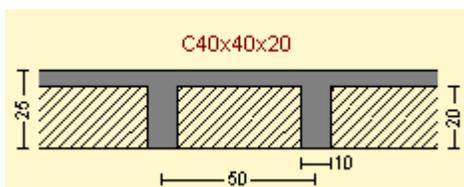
Perfil transversal losa $h=25\text{cm}$.¹
